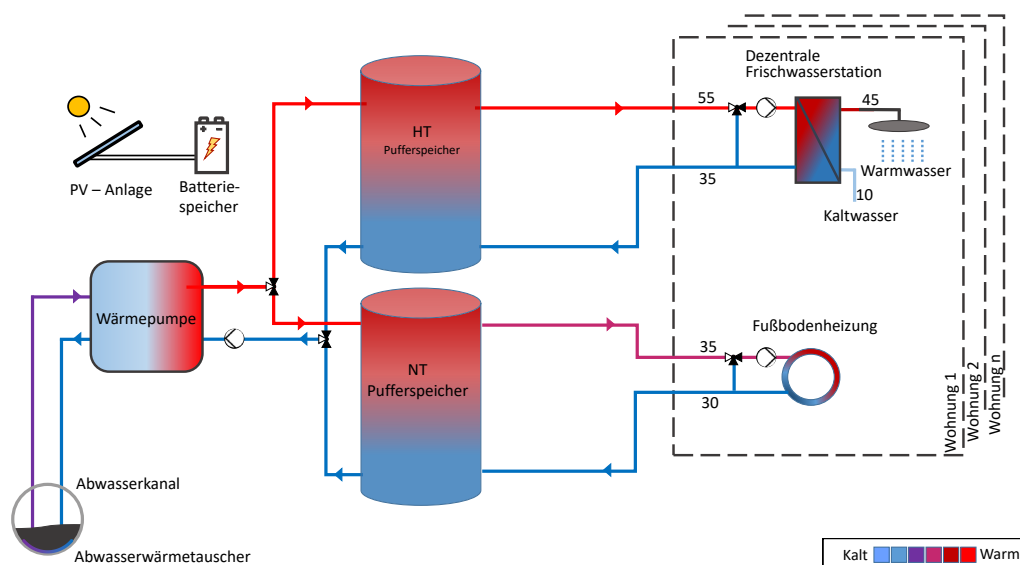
Vereinfachtes Haustechnikschema des Projekts Speicherstraße in Frankfurt mit Sole-Wärmepumpe mit Wärmequelle Abwasserkanal, Pufferspeichern, Vierleitersystem mit wohnungsweisen Frischwasserstationen und Fußbodenheizungen sowie PV-Anlage mit Batteriespeicher
